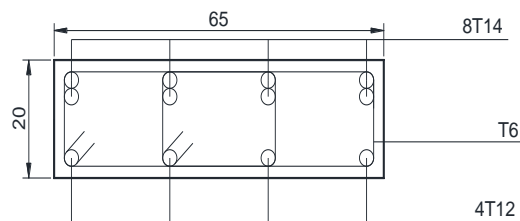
Coupe longitudinale d'une poutre noyée principale 65x20cm (plan régulier)
